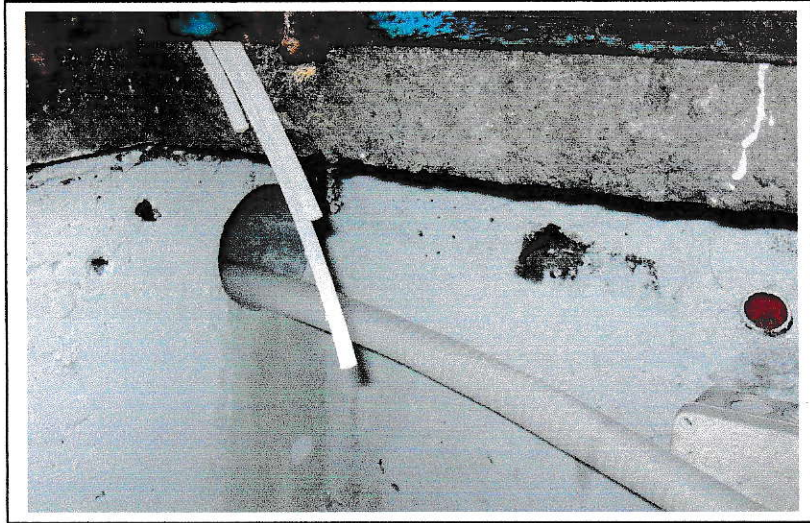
Ducto de descarga que llega directamente al alcantarillado.
